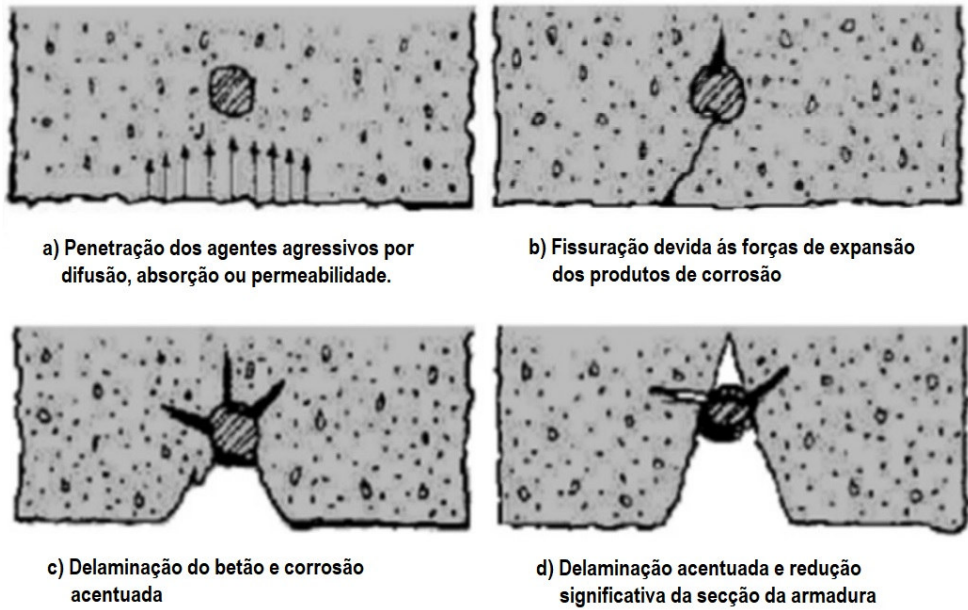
Progressão da corrosão de armaduras
